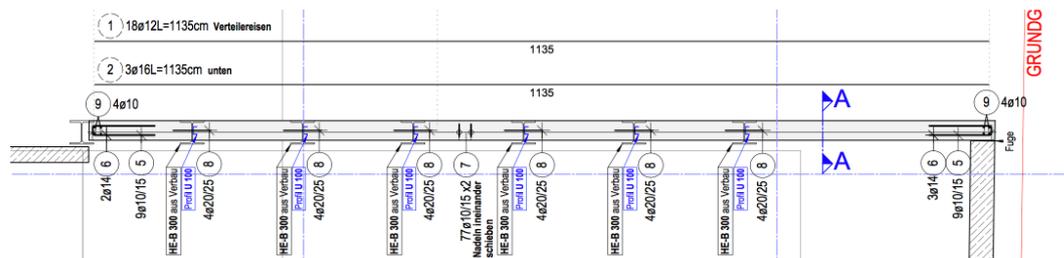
Bewehrungsplan Grundriss der Mauer
